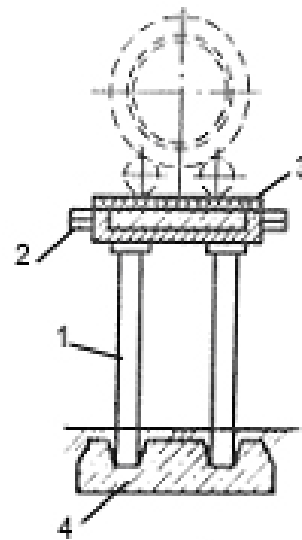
Схема рамного фундаменту: 1 – стійки; 2 – ригель;
